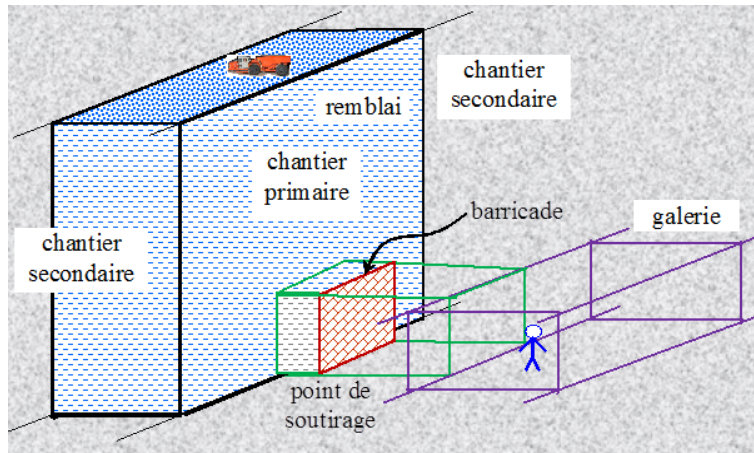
Présentation tridimensionnelle schématisée d'un chantier avec une barricade installée au point de soutirage (adaptée de Li et Aubertin, 2011).
